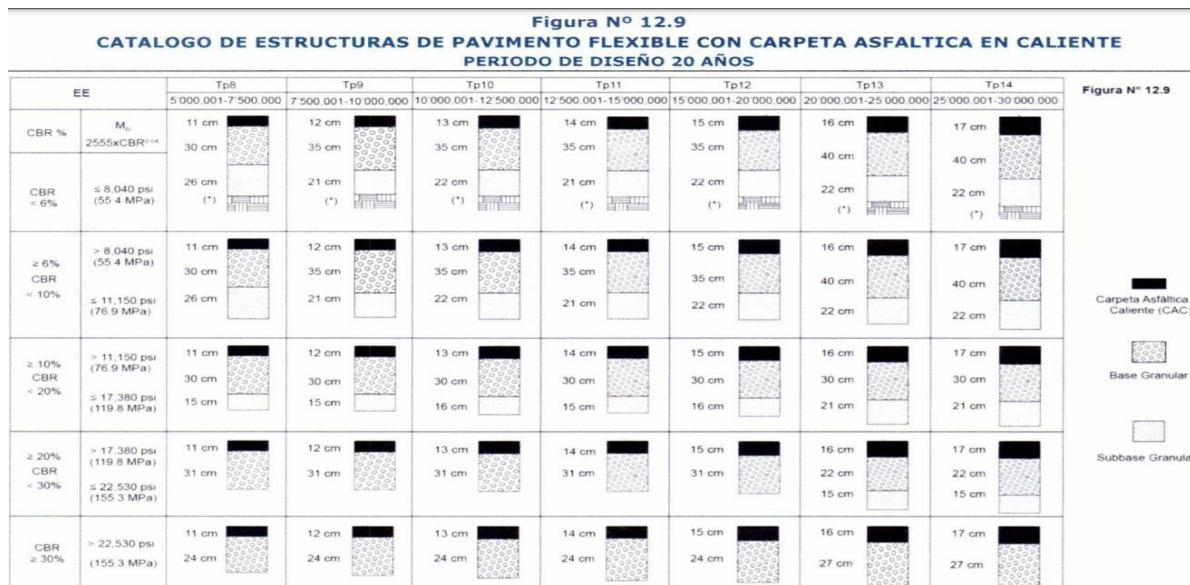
Estructuras del pavimento flexible con carpeta asfáltica en caliente, en periodo de 20 años.
